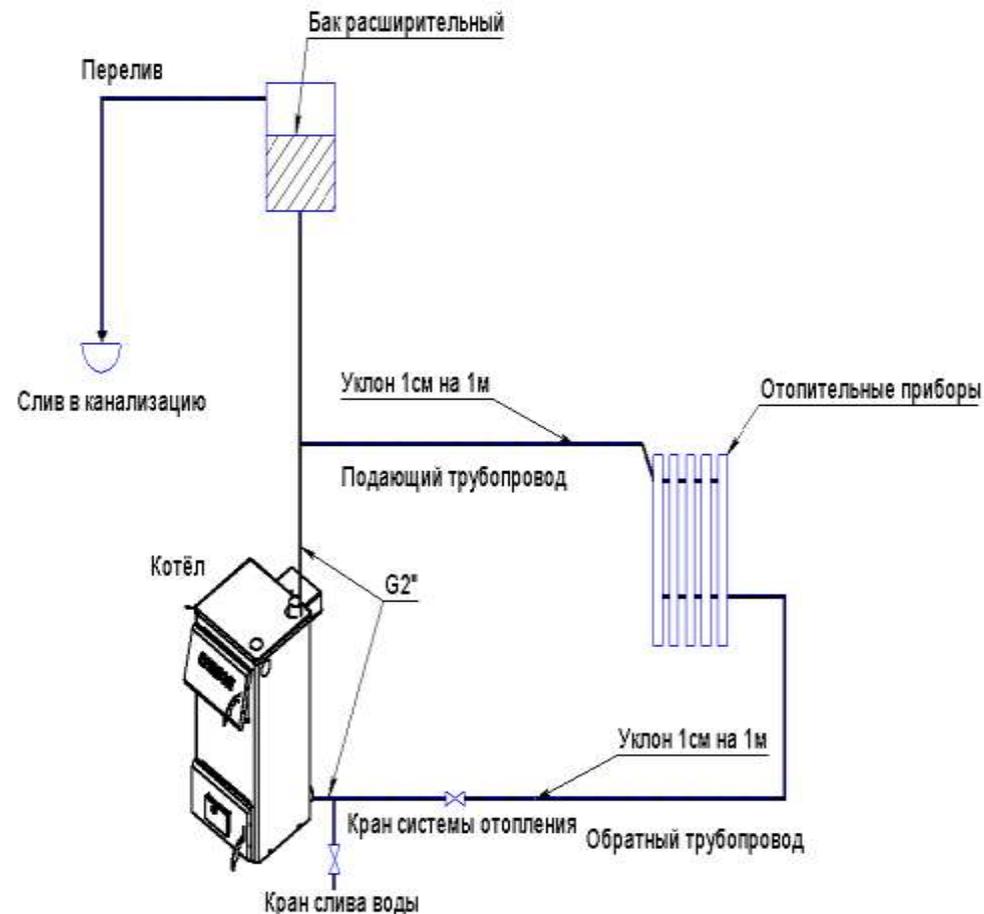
Схема открытой системы водяного отопления, применяется расширительный бак открытого типа.
